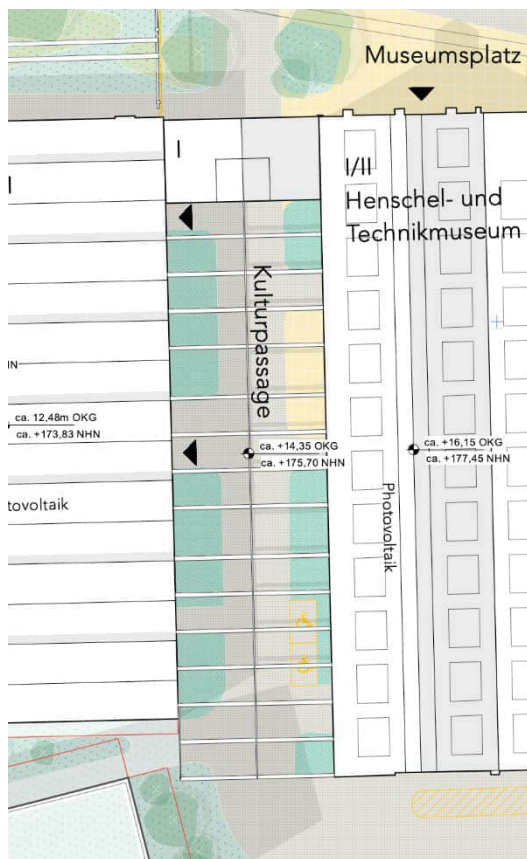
Dachaufsicht R1 Schiff 1, Kulturpassage, coido architects
